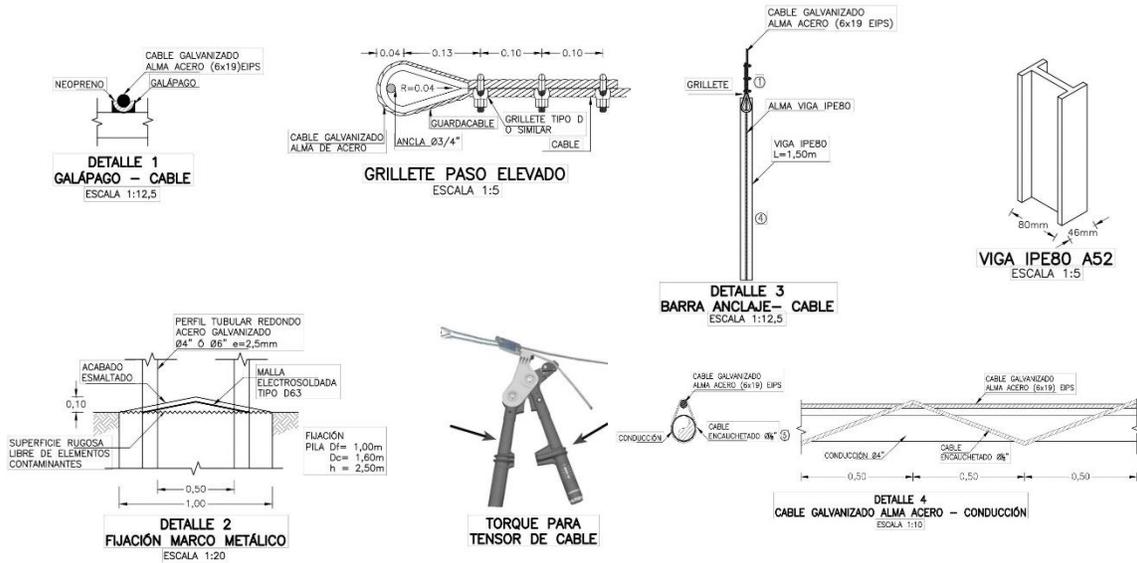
Diseño de estribos – Plano detalles de fijación del cable al marco metálico.
